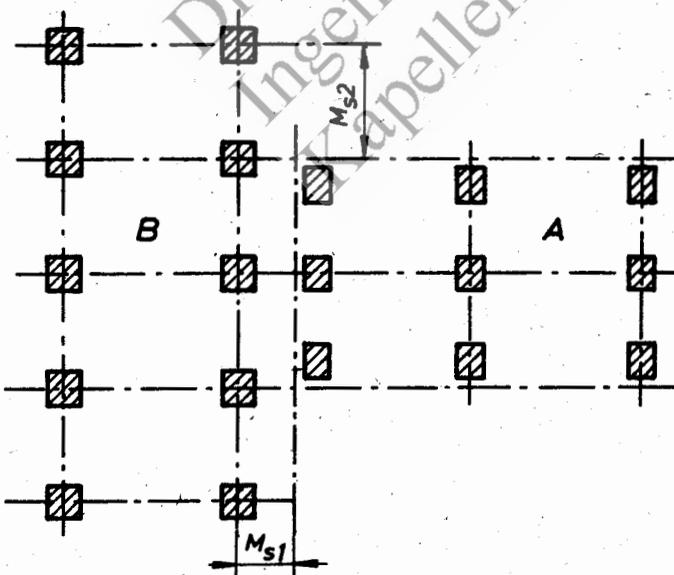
Gebäudeanschluß zwischen ein- (A) und mehrgeschossigen (B) Skelettkonstruktionen
